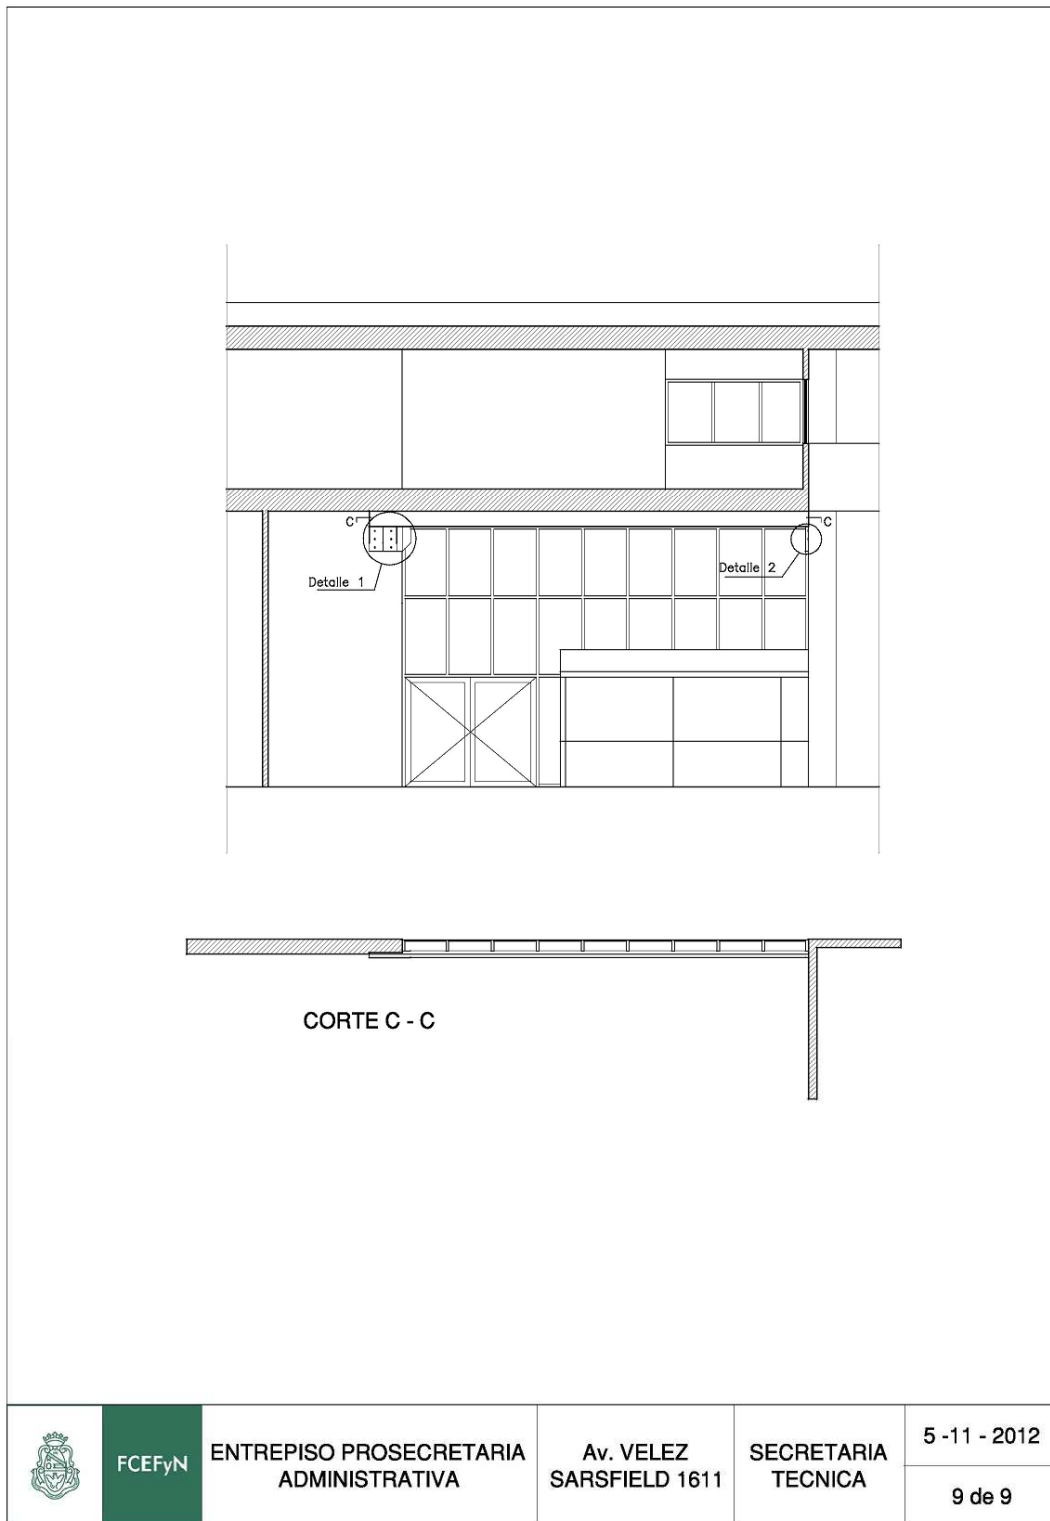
Plano 9 – Fuente: Digitalización de planos originales
